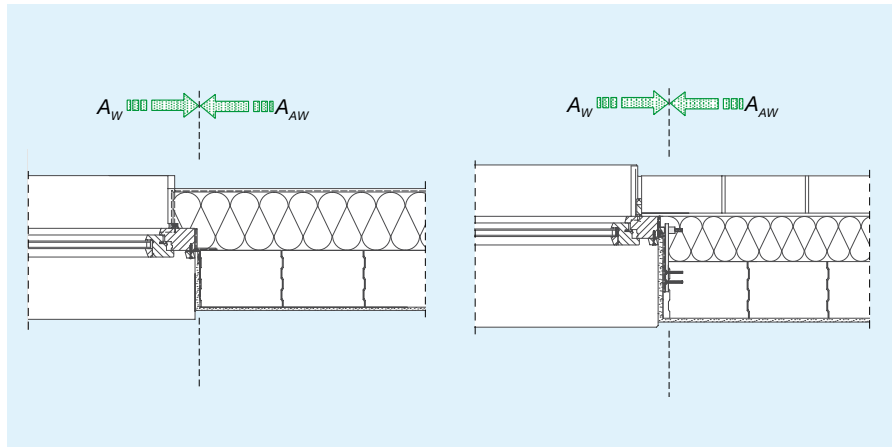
Ermittlung des lichten Rohbaumaßes bei Fensteröffnungen (stumpfer Anschlag, zweischaliges Mauerwerk, mit Innenanschlag); A_w = Fensterfläche, A_{AW} = Fläche Außenwand
